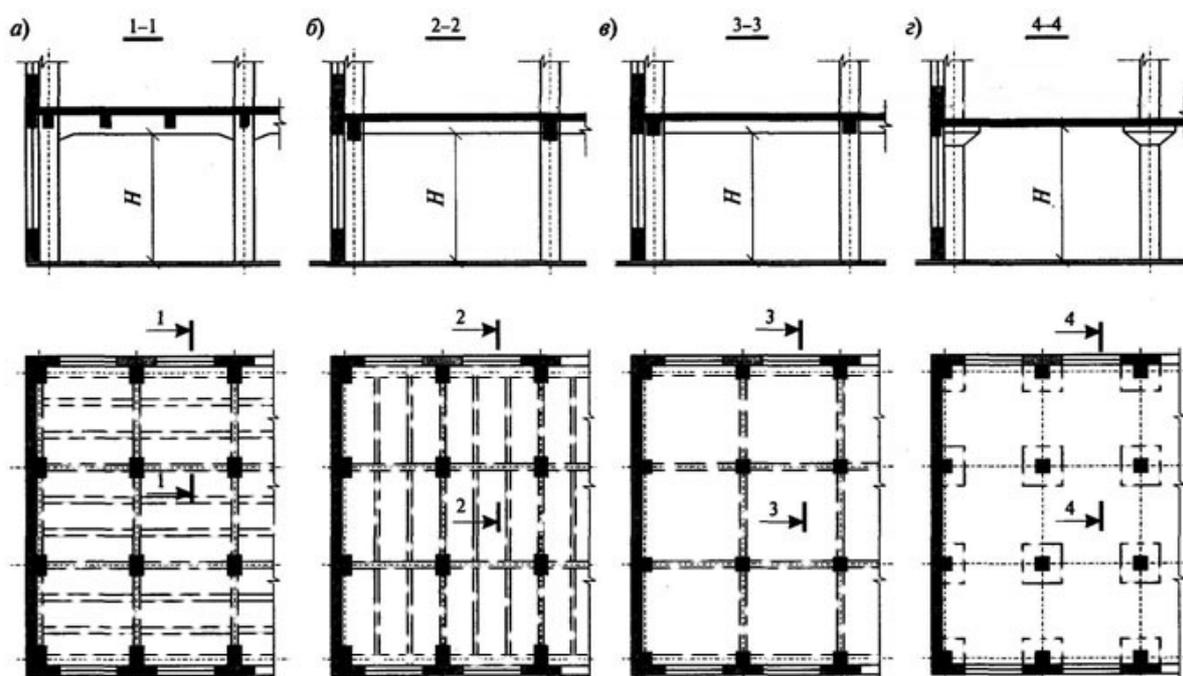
Схемы монолитных железобетонных каркасов производственных зданий:
